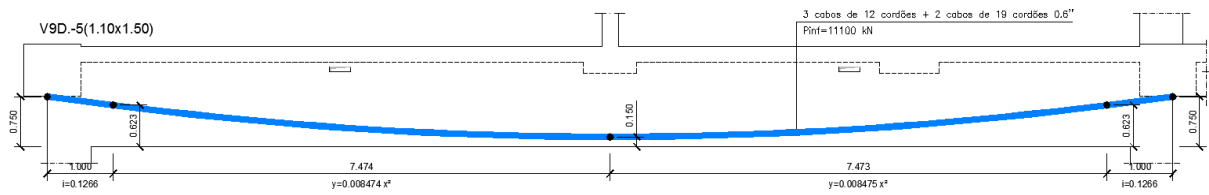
Viga do auditório: traçado de cabo de pré-esforço
